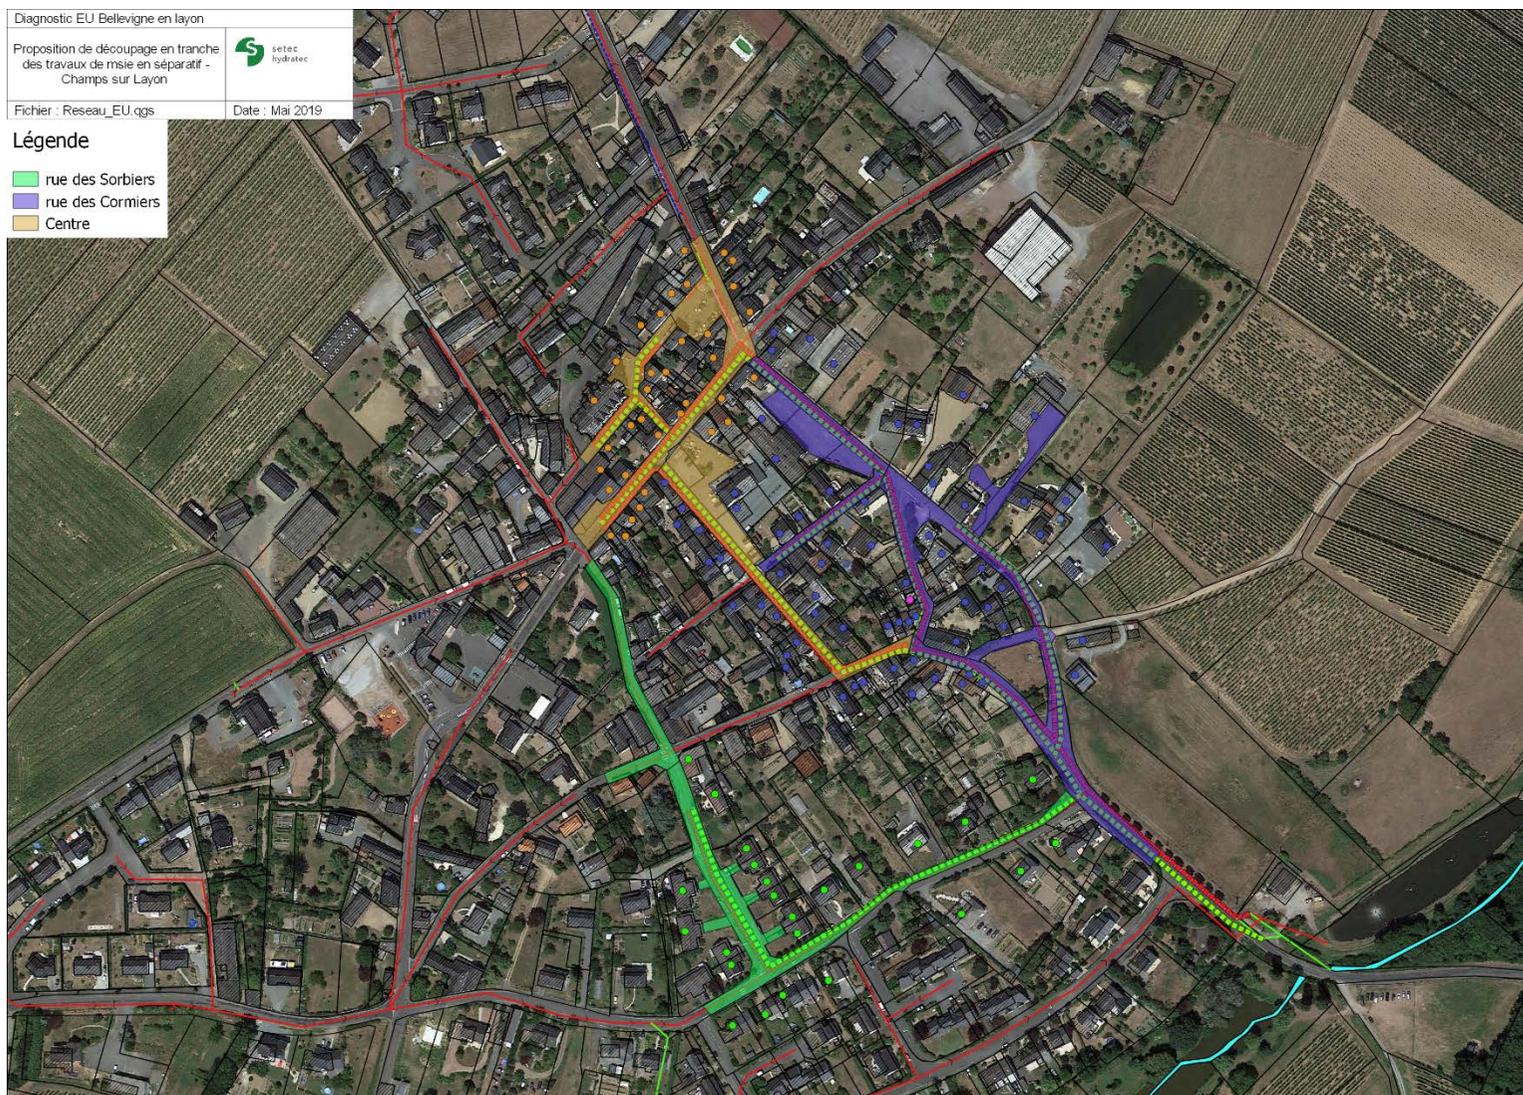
proposition de découpage par tranche des travaux de mise en séparatif _ Champ sur Layon
